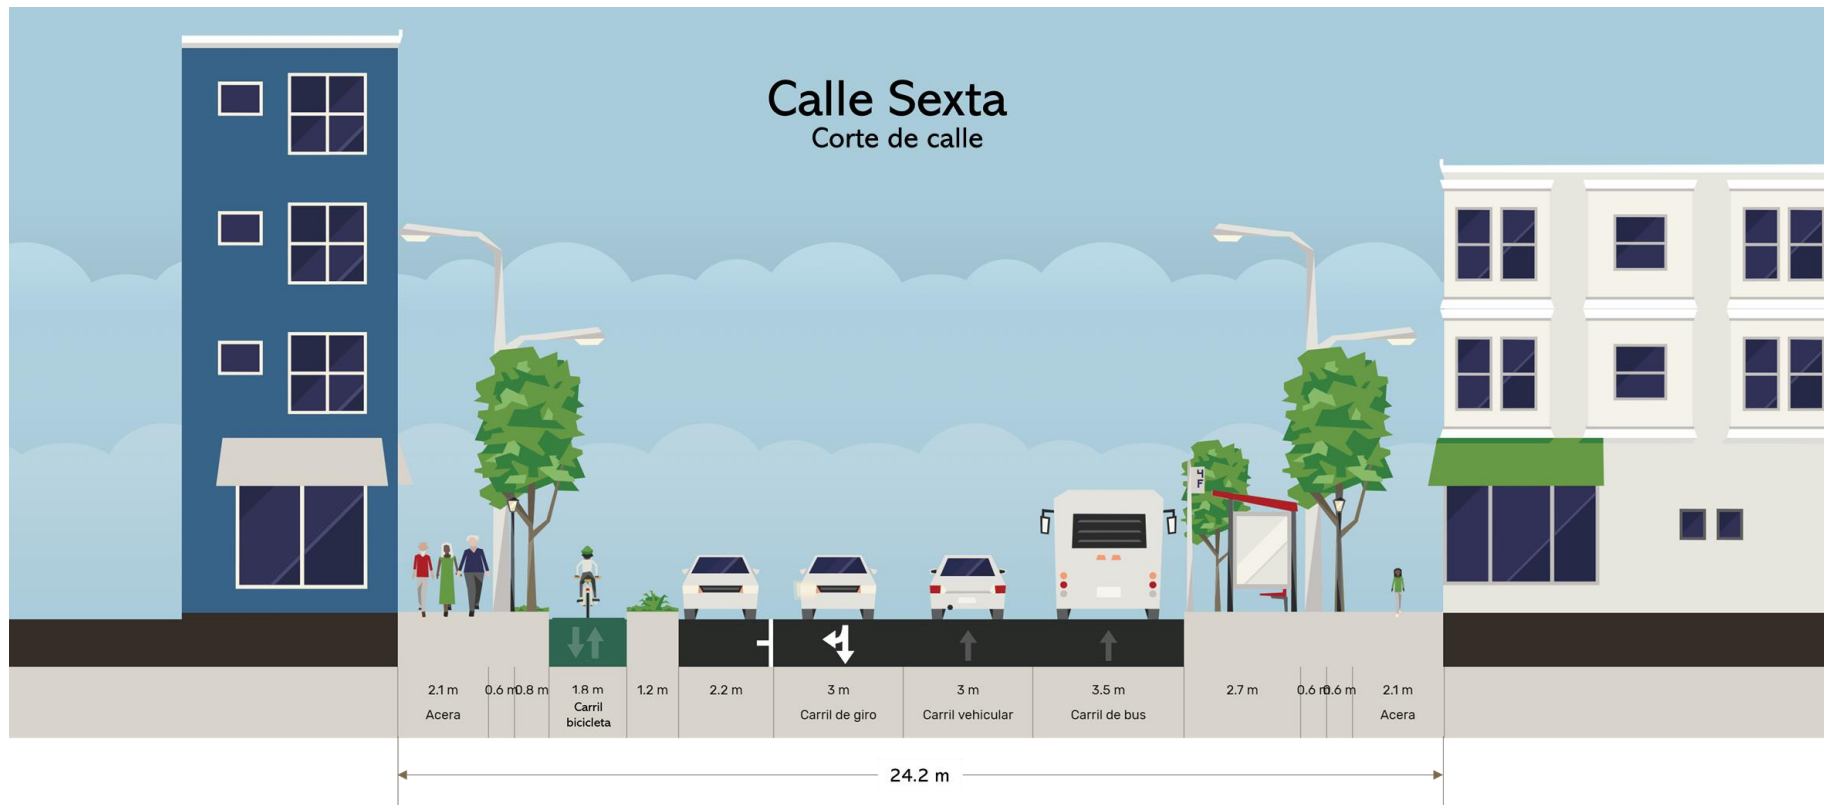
Detalle distribución de propuesta para calle Sexta (corte).
